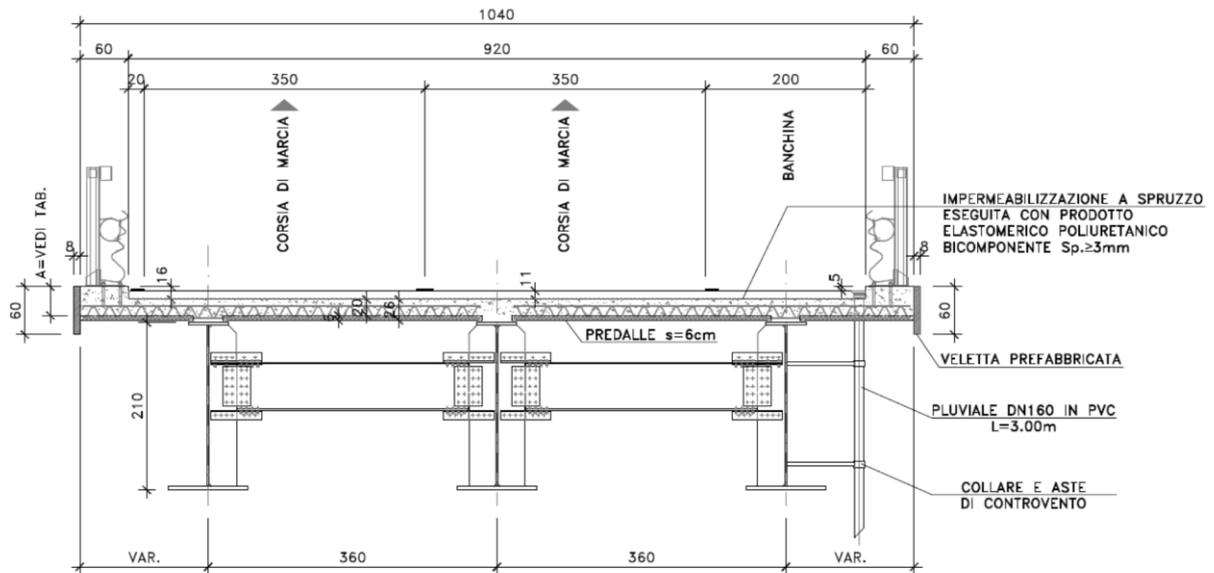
Sezione trasversale nuovo impalcato a 3 travi – Sezione corrente
